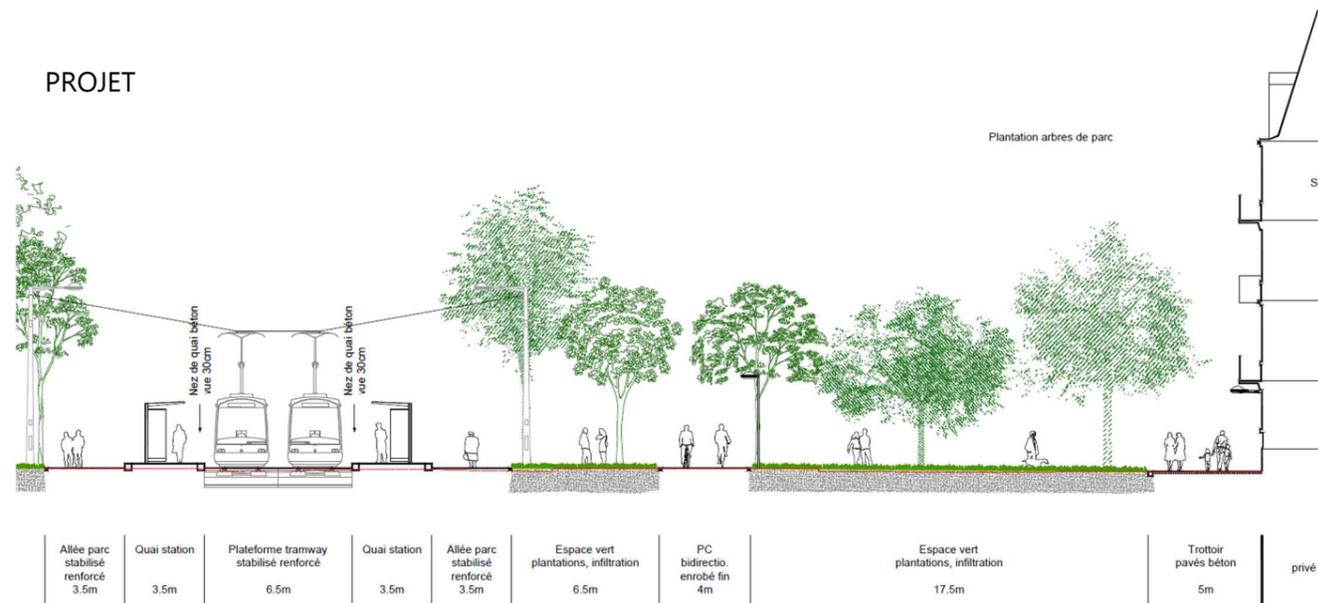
Coupe station Place de Haguenau (source : AVP GETAS, 2023)
